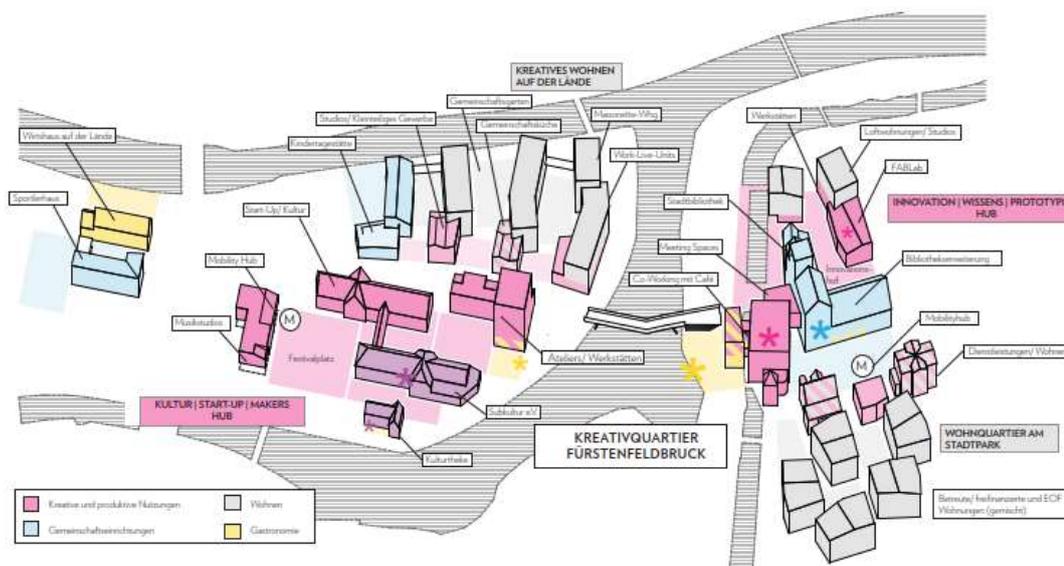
Wettbewerb Siegerentwurf, Baukörper mit Nutzungen
